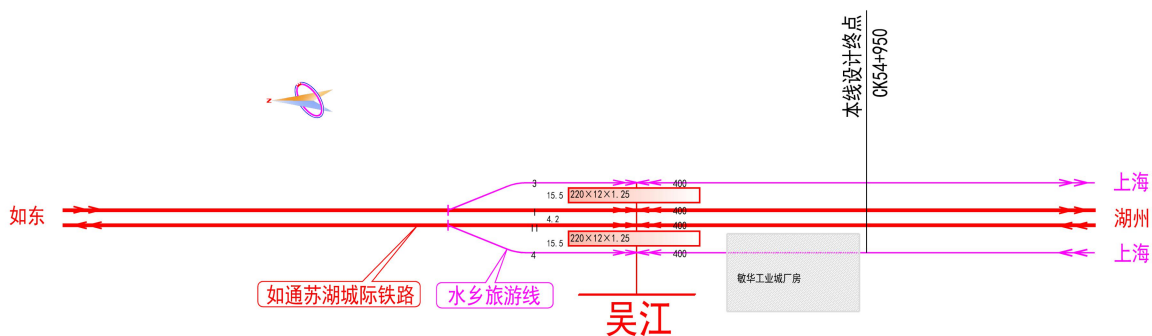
水乡旅游线车站接轨方案平面布置示意图
